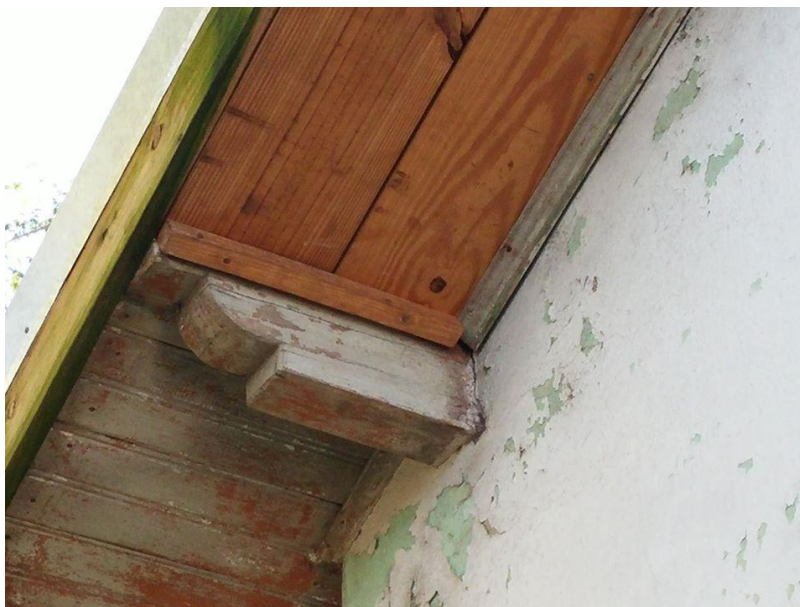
detalhe do acabamento externo da cobertura, no madeiramento do telhado, que apresenta detalhe nas terças salientes nos e deixadas aparente
